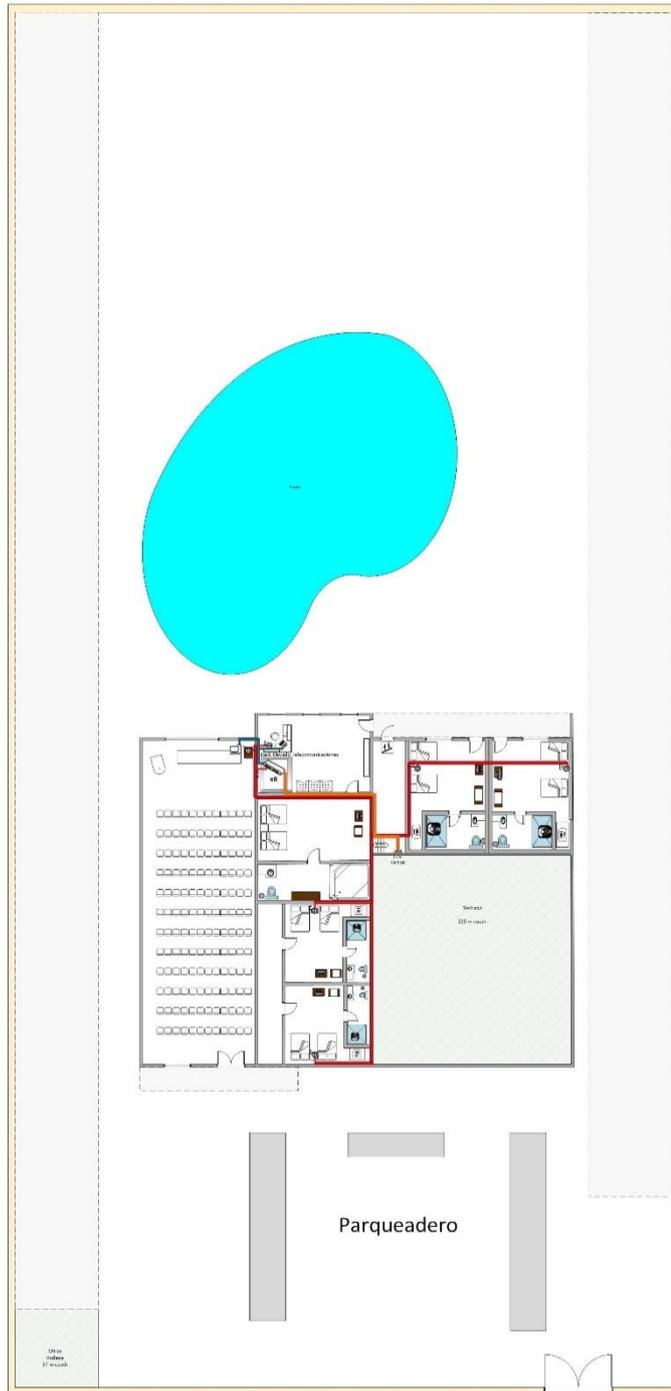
Diseño General y Cableado del Hotel, Planta Alta.
